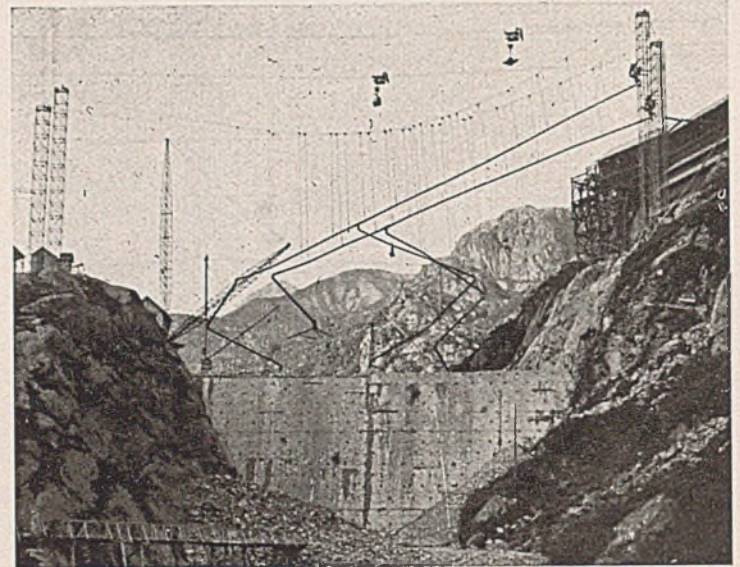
Gesamtansicht der Gußbetonanlage (29. VIII. 23).
